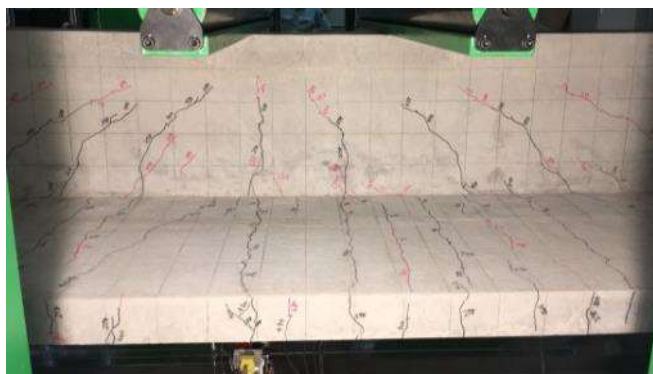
No.1 試験体の最大荷重時ひび割れ性状
